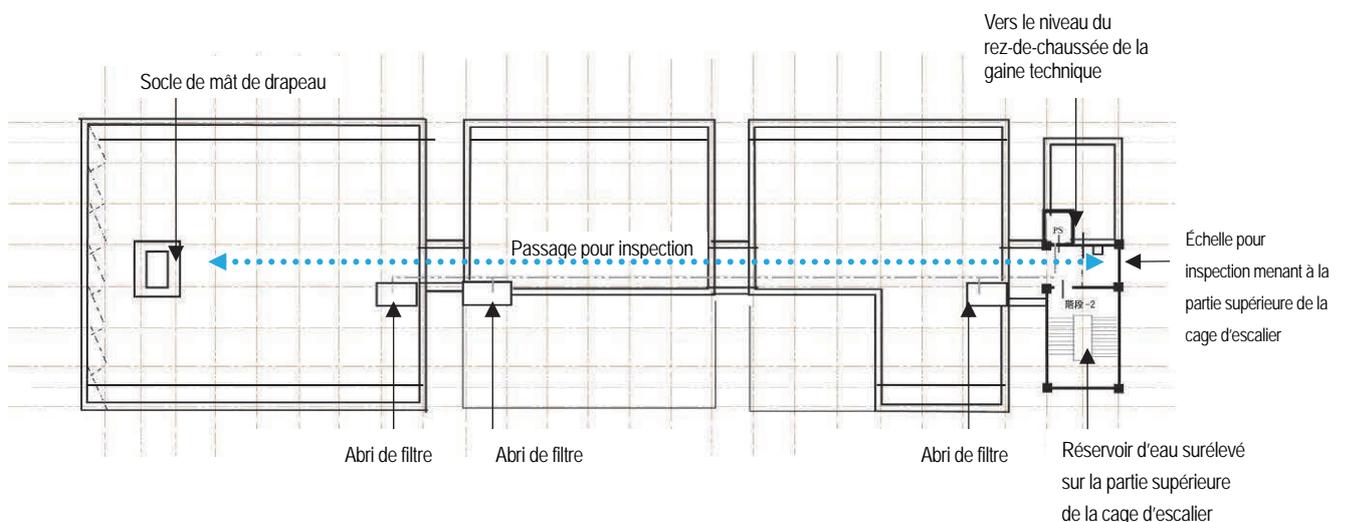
Vue en plan du penthouse et du toit-terrasse
